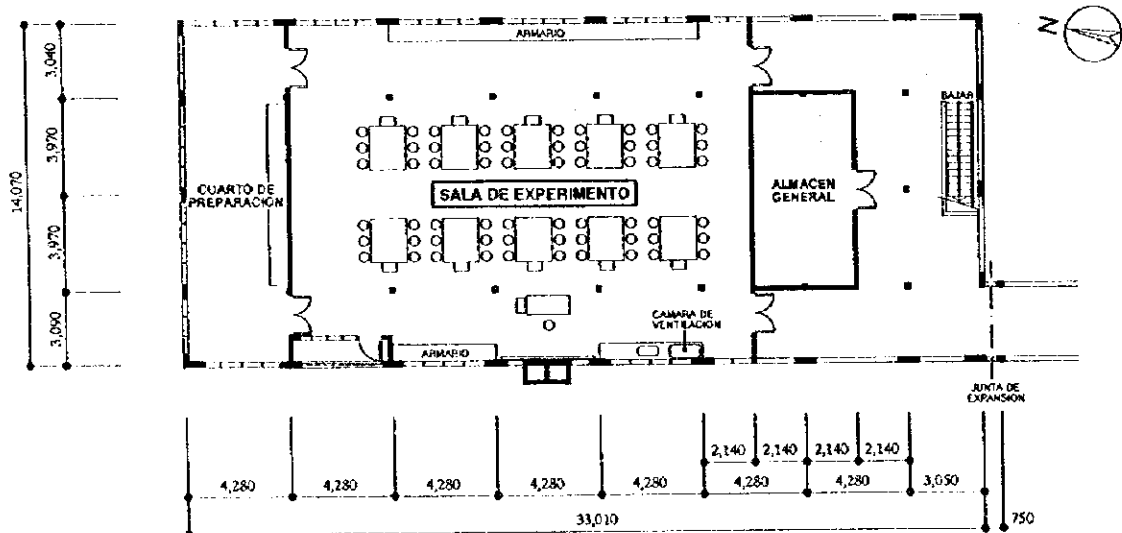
Plano del plan de sala de experimento por remodelación
